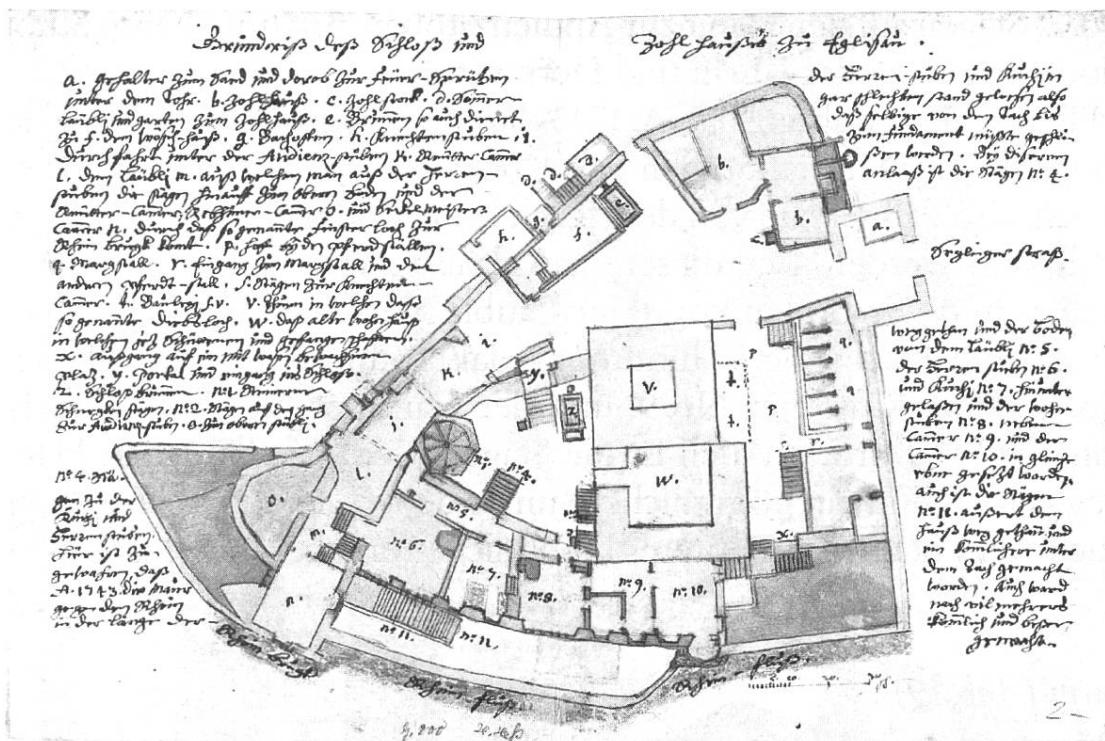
Grundriß deß Schloß und Zohl Haußes zu Eglisau, 18. Jht.
